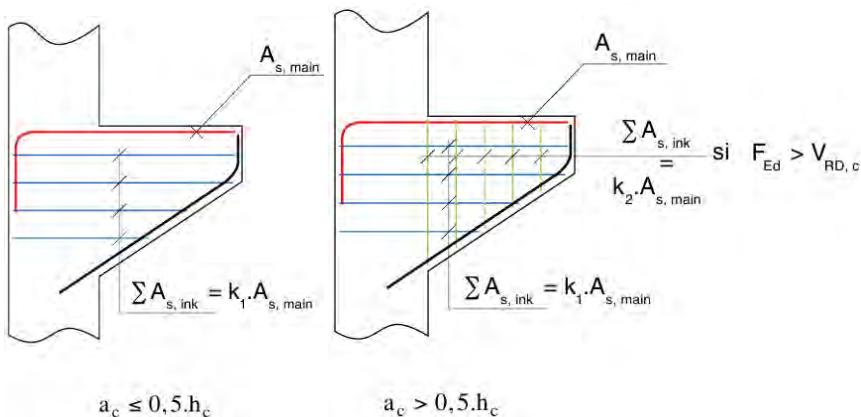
К расчету армирования консоли вертикальными хомутами
